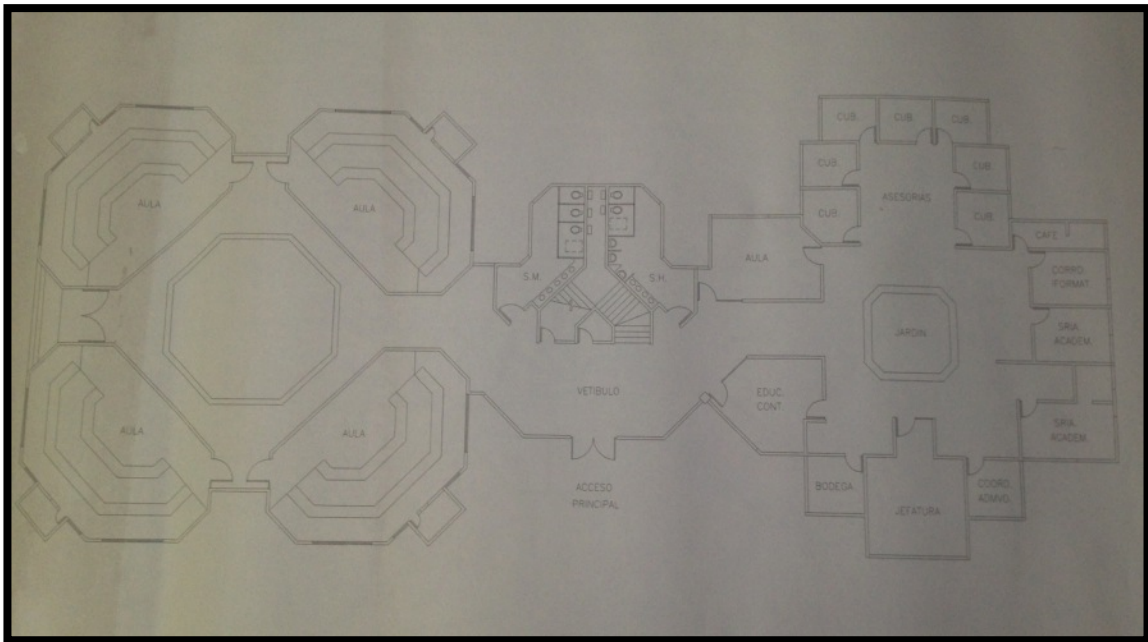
Planta baja del edificio de posgrado de Contaduría y Administración.
